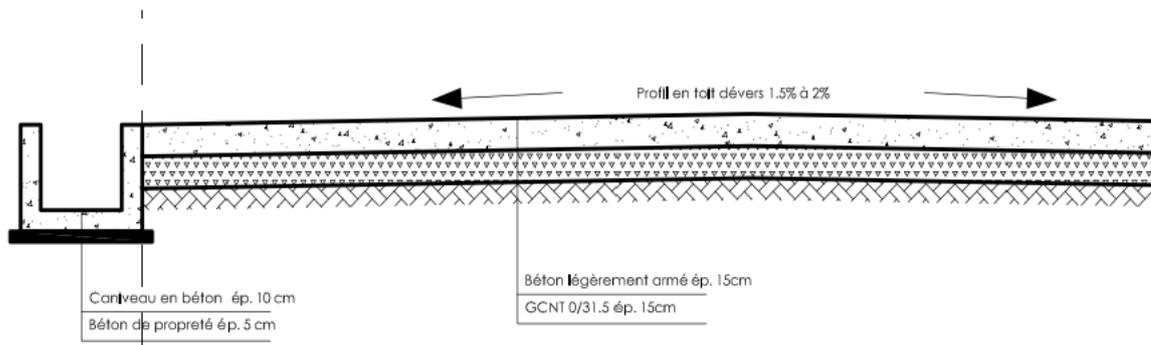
Plan type de la coupe transversale d'une voie carrossable
